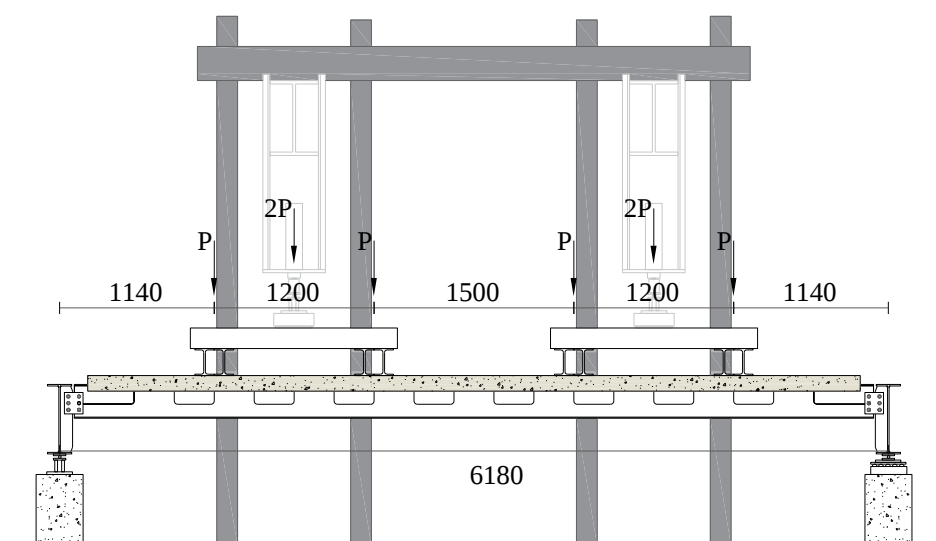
Esquema do sistema de ensaio (dimensões em mm)
